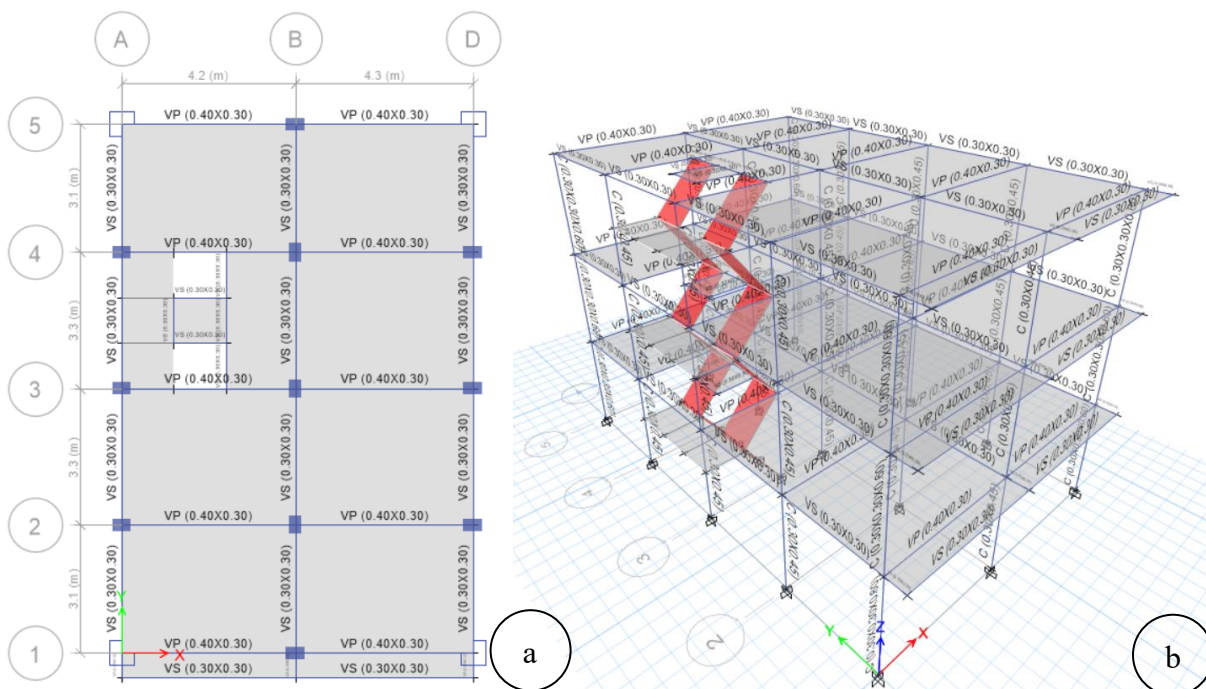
Plano del primer nivel y modelo 3D de la edificación Etabs. (a) Configuración estructural de la edificación propuesta, (b) Vista 3D de la configuración estructural.
